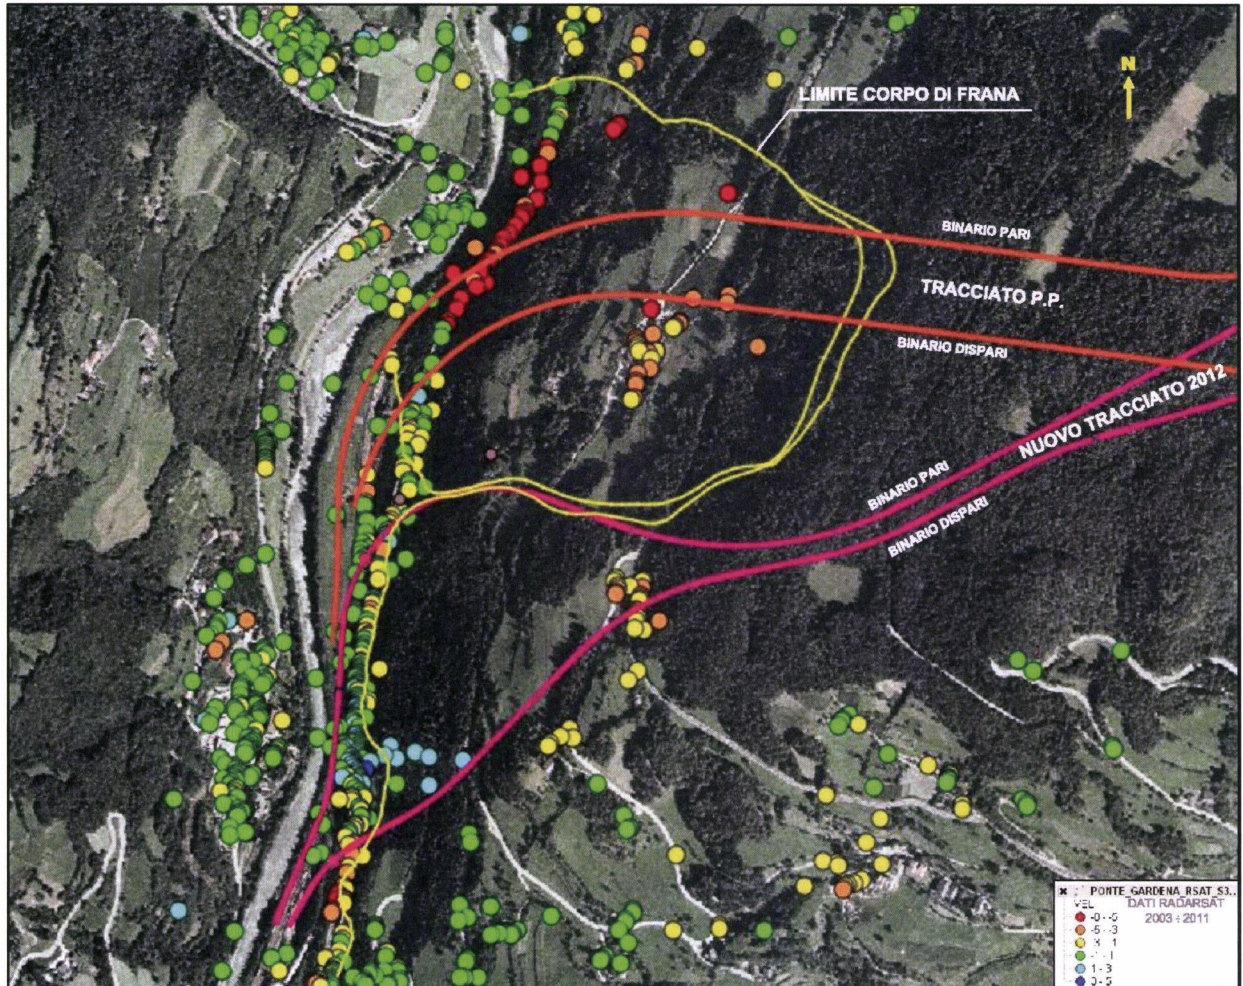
Planimetria con i dati di monitoraggio satellitare e con lo sviluppo del nuovo tracciato 2012, posto a confronto con il tracciato di Progetto Preliminare. In giallo l'estensione dell'area di frana.
